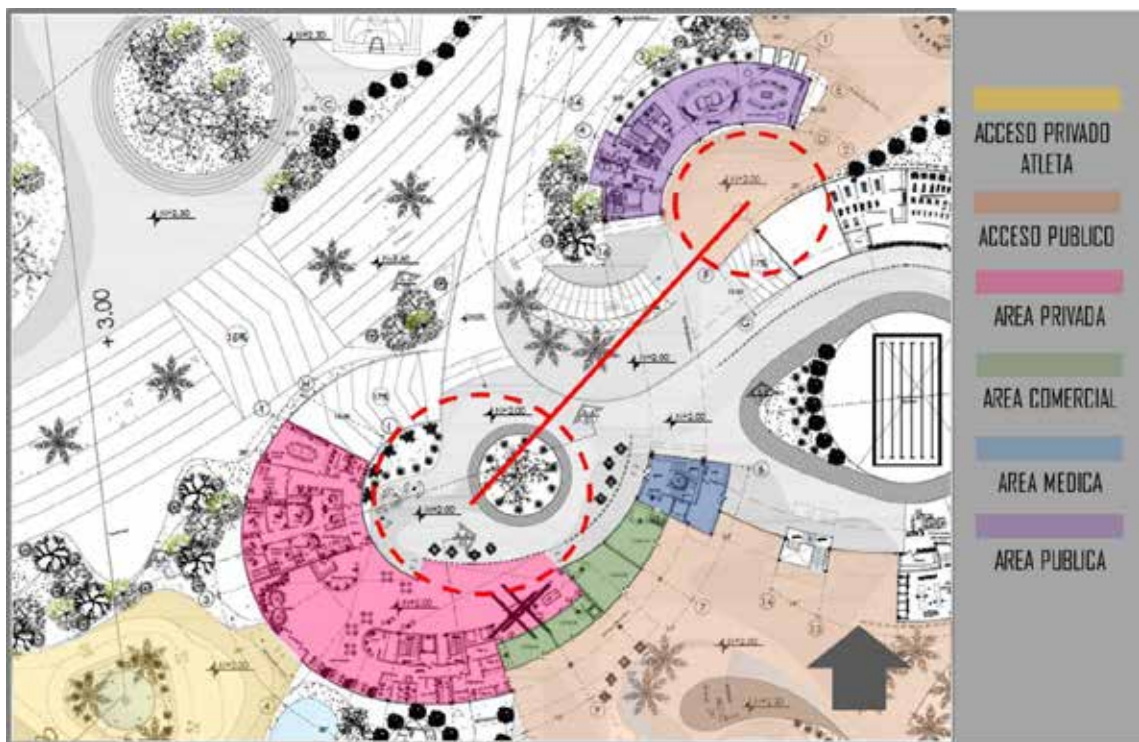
Edificio A, Planta Baja con sus Areas. Fuente: Duarte De Andrade y Otros
